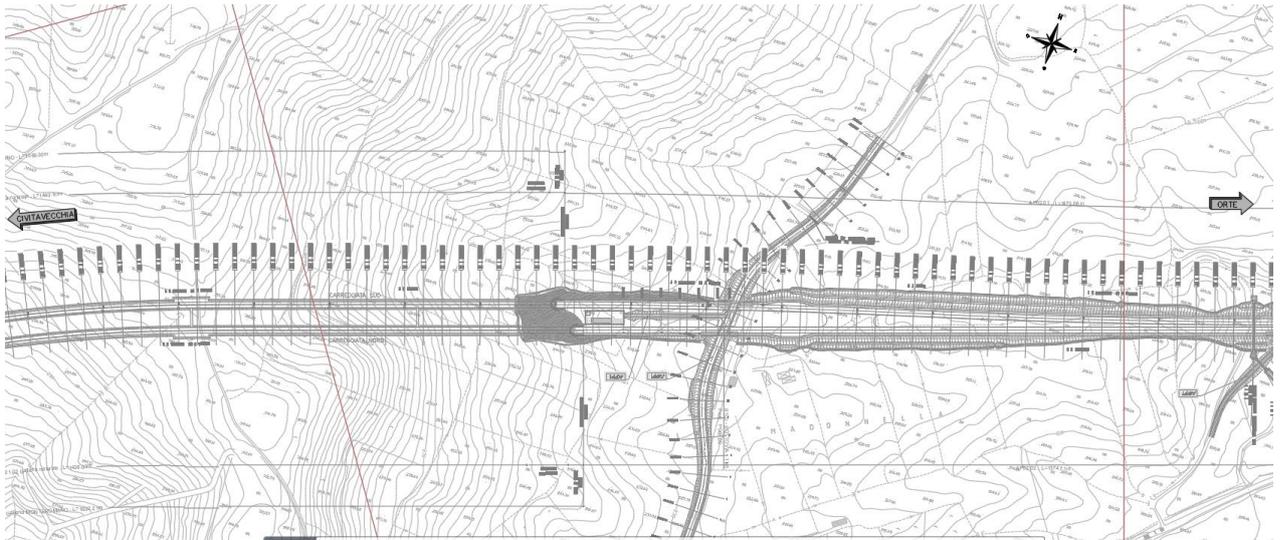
Stralcio planimetria inizio galleria Monteromano (L=1566,30m) e sottovia
